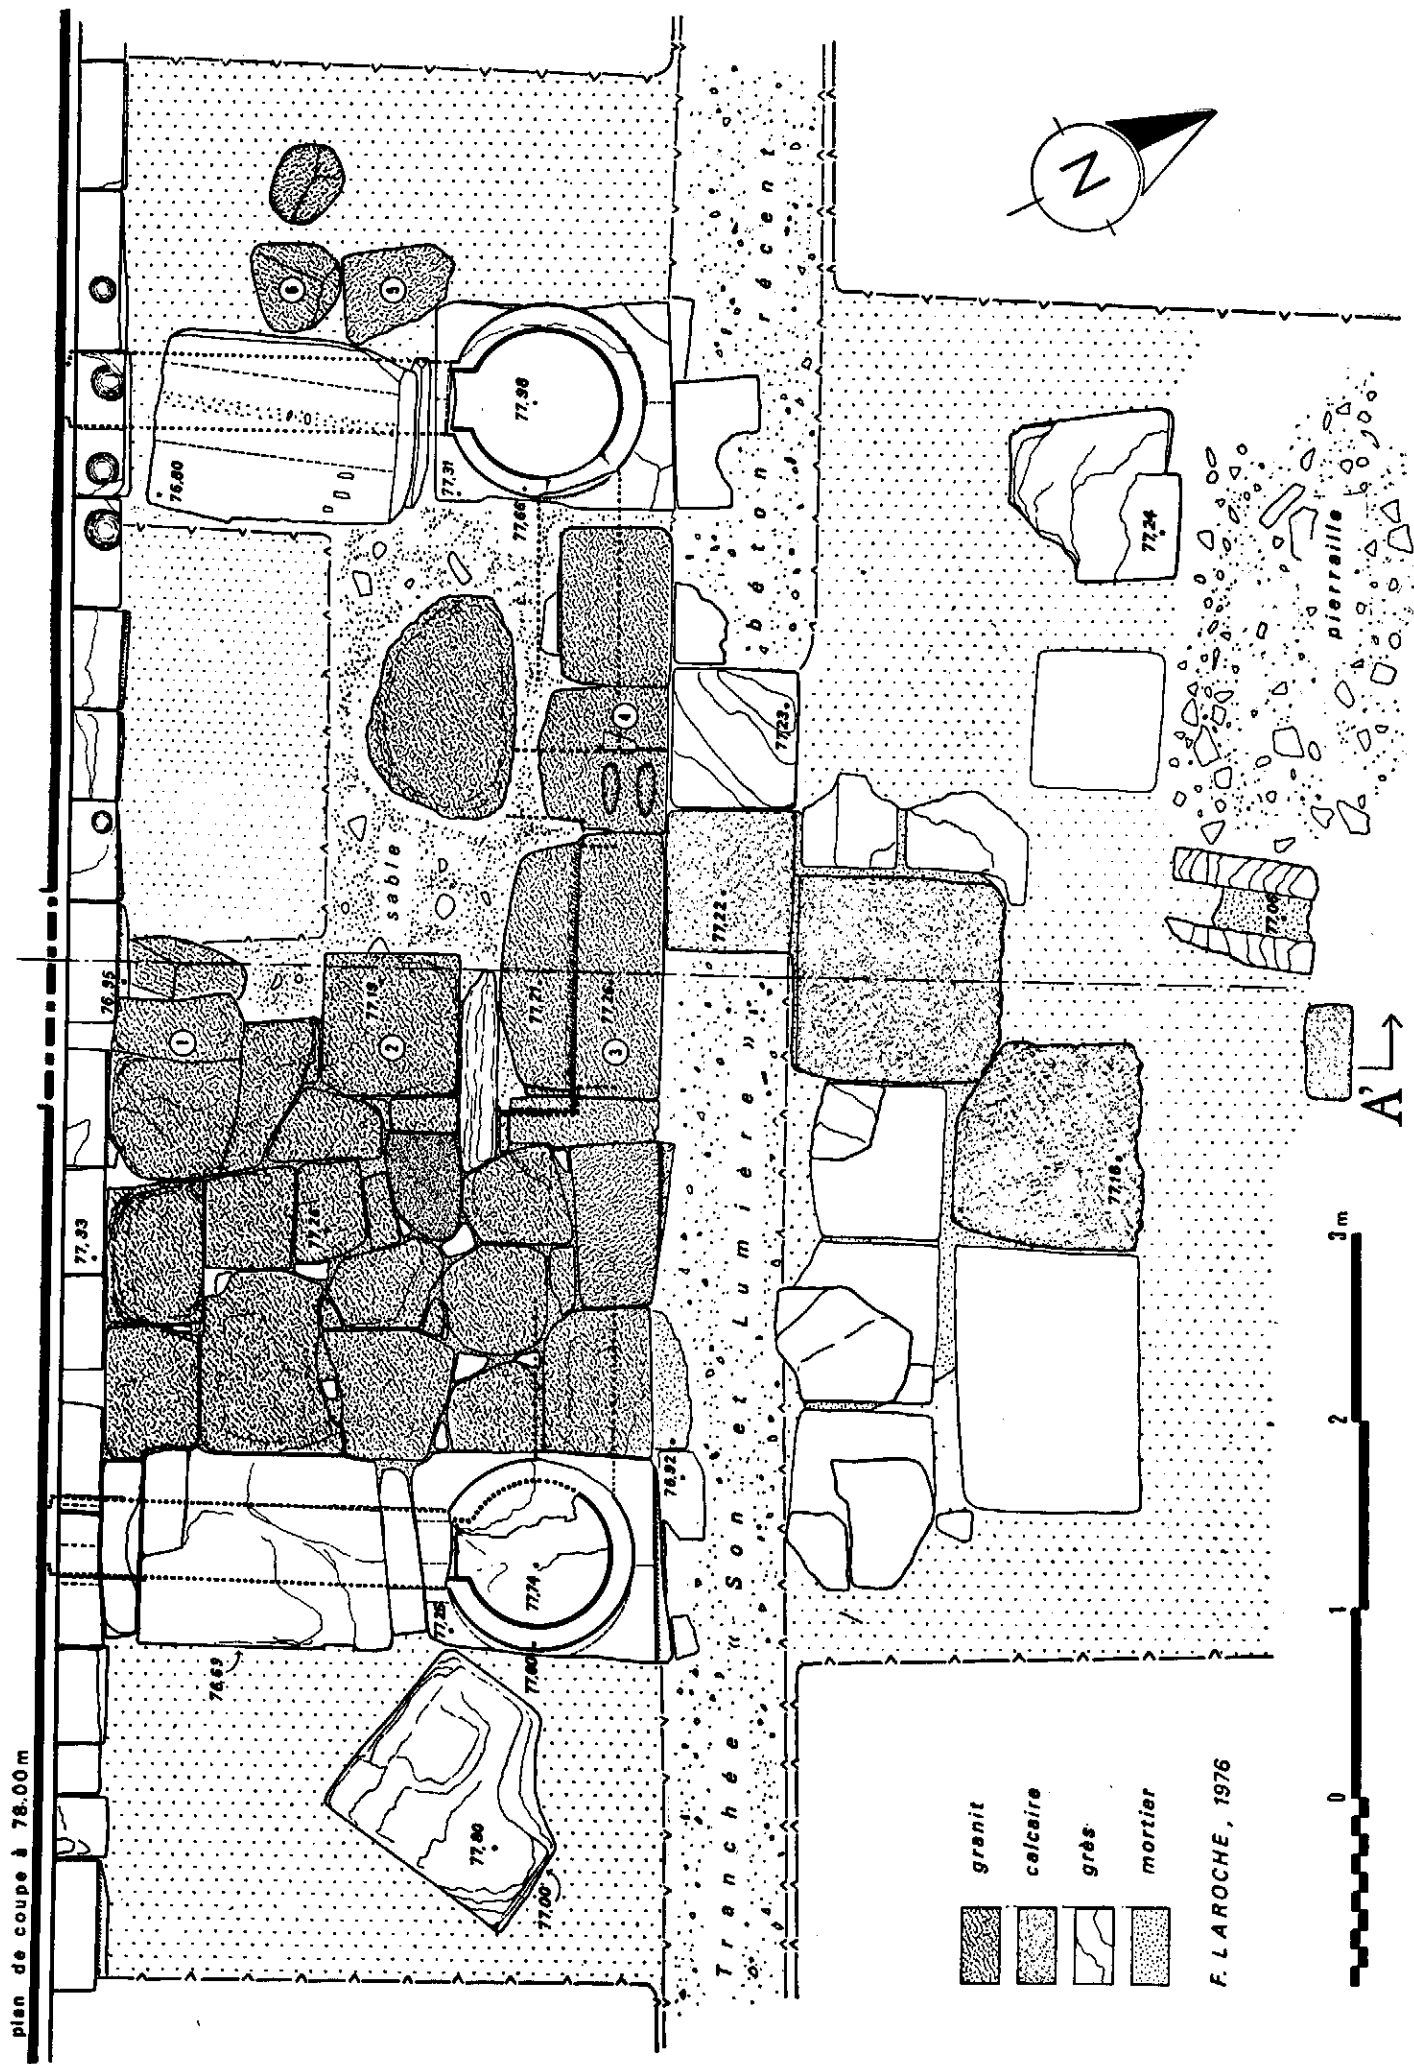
Plan d'état des lieux (VI, M, 16).
